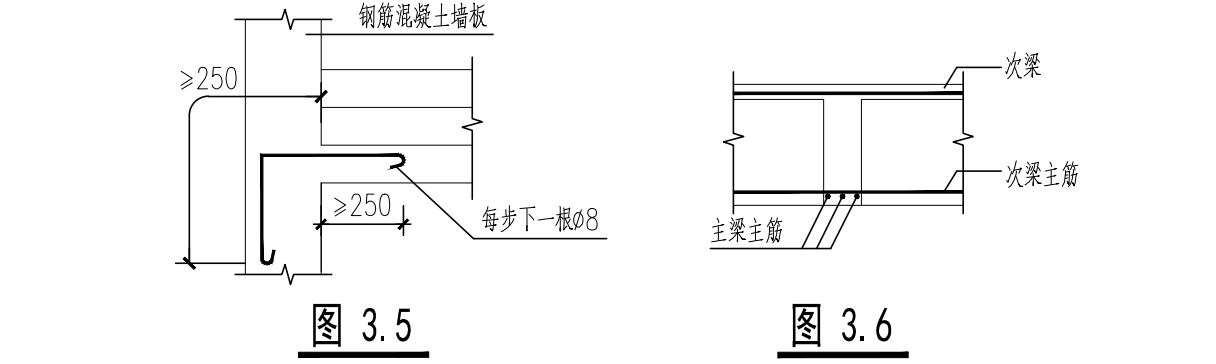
梯段板的非受力方向与钢筋混凝土墙板紧靠时
